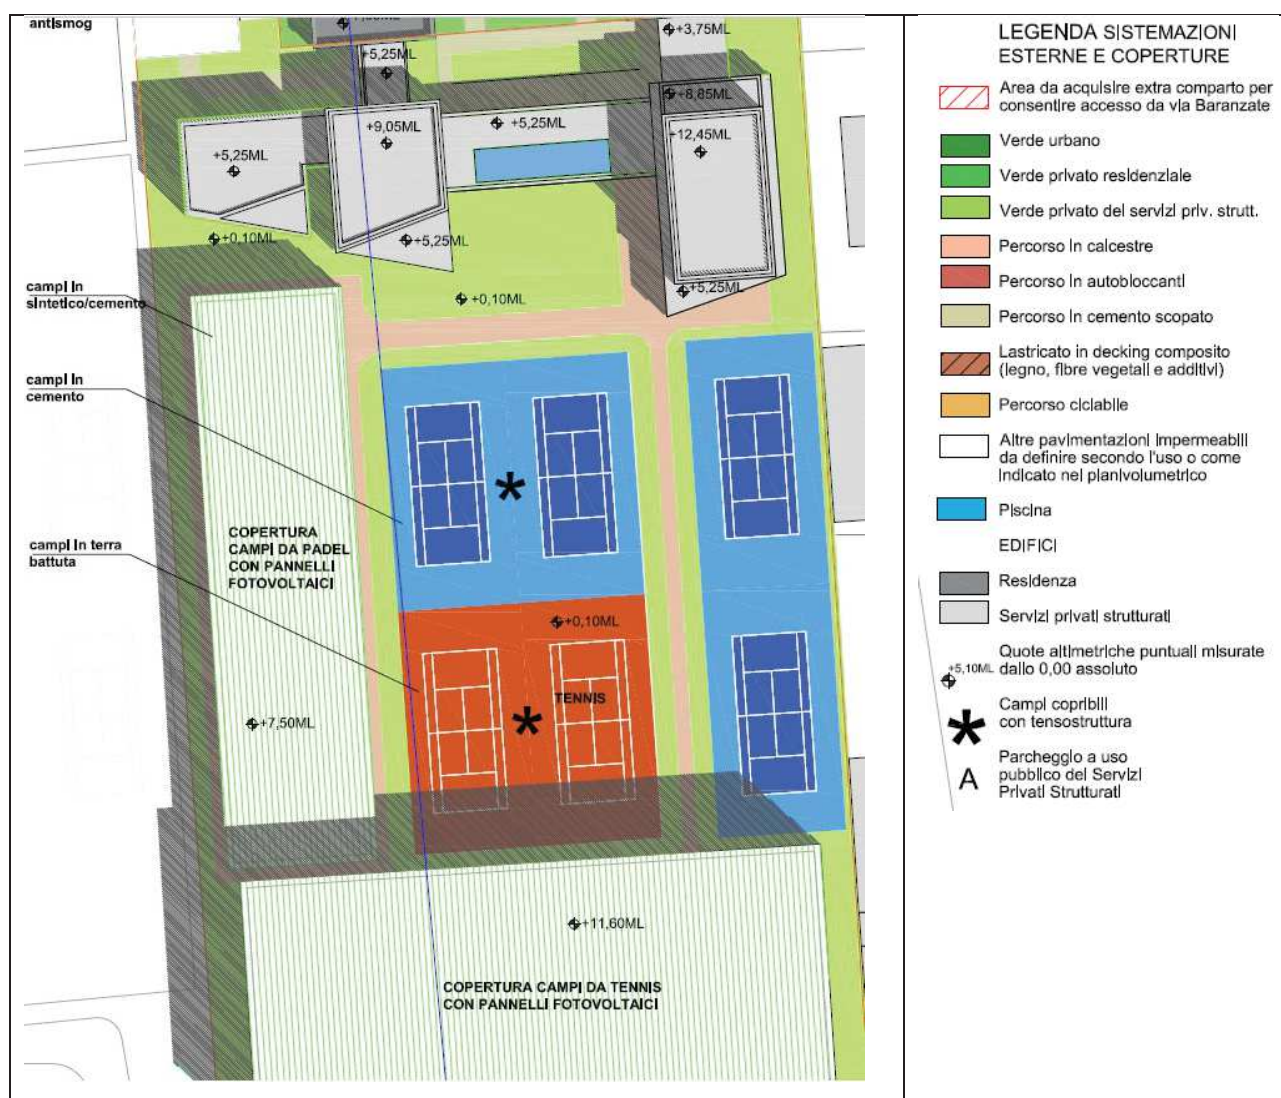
Dettaglio dell'area sportiva (fonte: tav.4 Planivolumetrico di PA)
